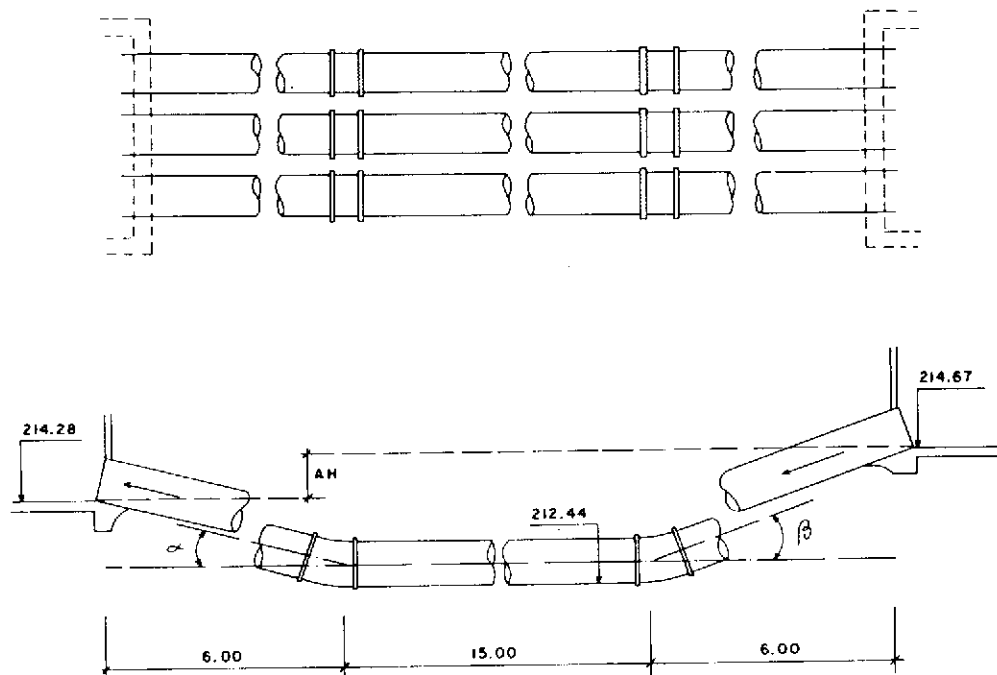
Detalles de sifón invertido (Planta y perfil).
